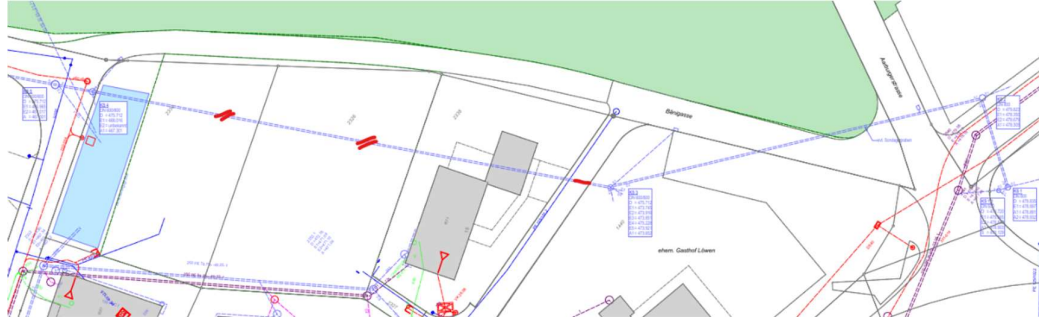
Situation Bestand, Abschnitt Kirchenweiher - Kreuzung Bänigasse
